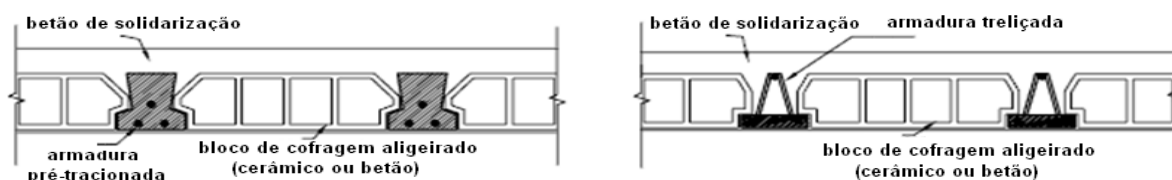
Exemplo de laje com vigotas de betão armado (Magalhães, 2013).
